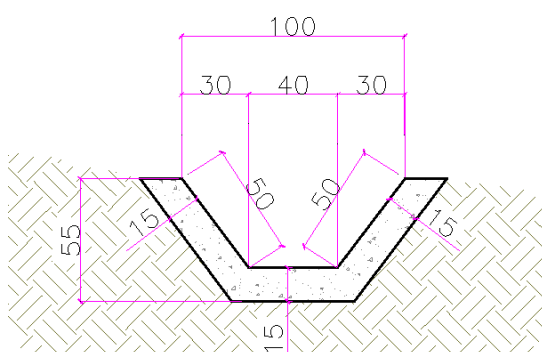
Canaleta de concreto armado, folha 01 do projeto estrutural.
